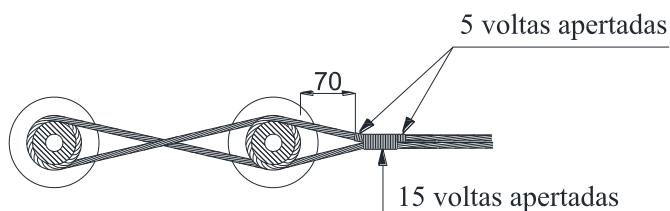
Amarragens e ligações – Estrutura primária – Duplo fim de linha
